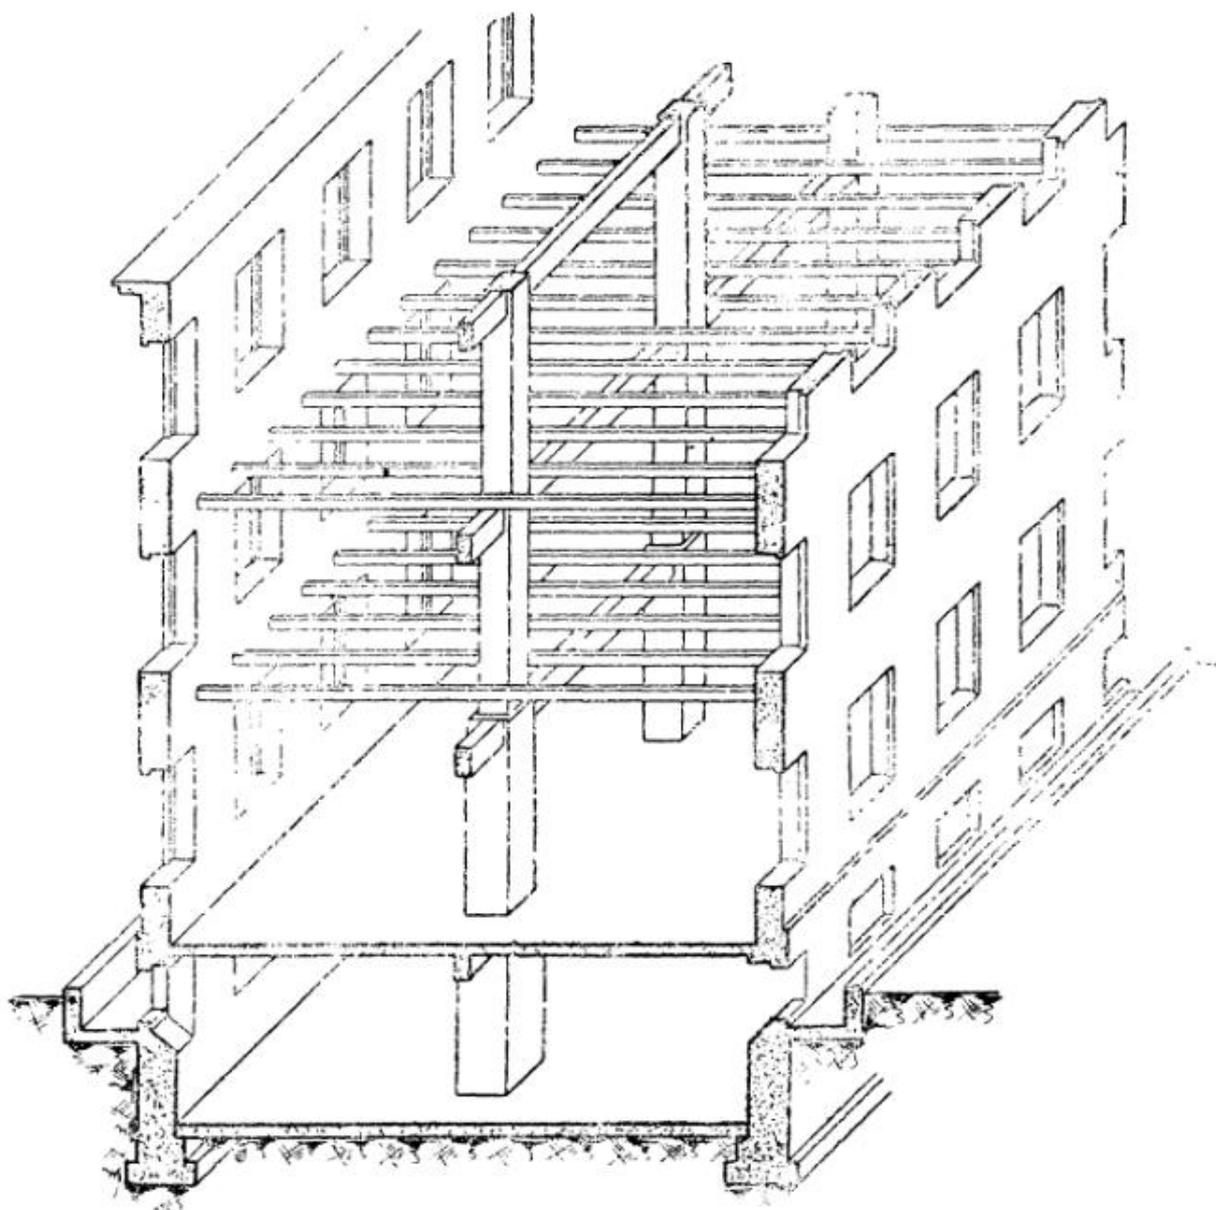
Трехэтажное здание с прямоугольными прогонами и с перекрытиями по деревянным балкам
